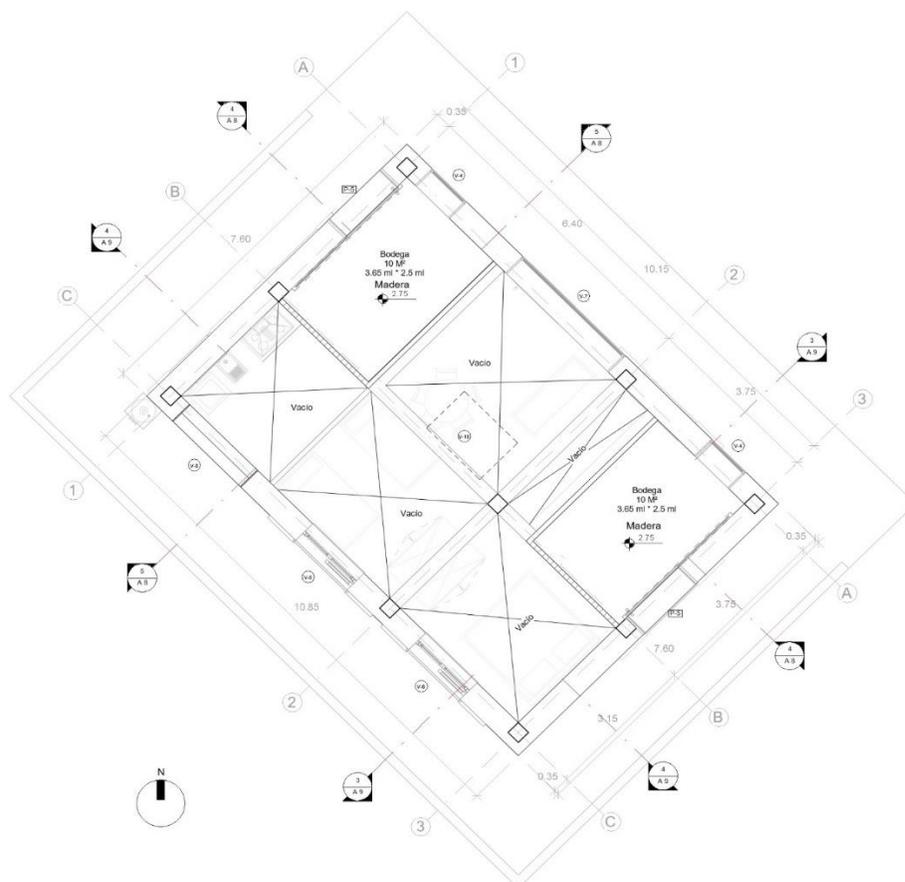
Planta Arquitectónica piso 1 etapa 1
